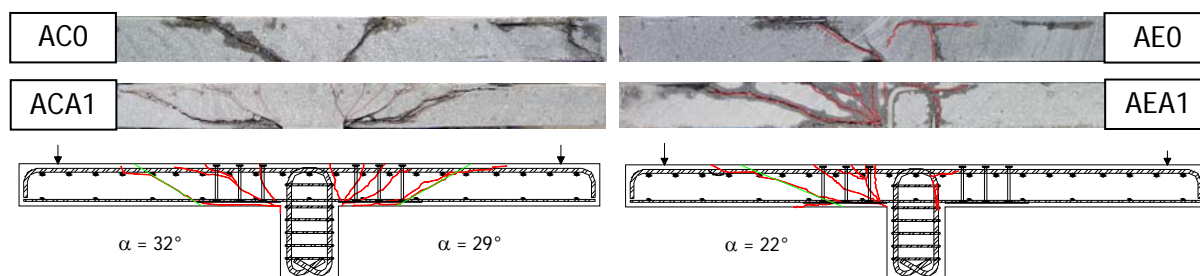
Cortes transversais dos modelos de laje. Carregamento centrado (à esquerda) e excêntrico (à direita). Indicação do ângulo (α) formado entre a fenda de rotura e o plano da laje.
